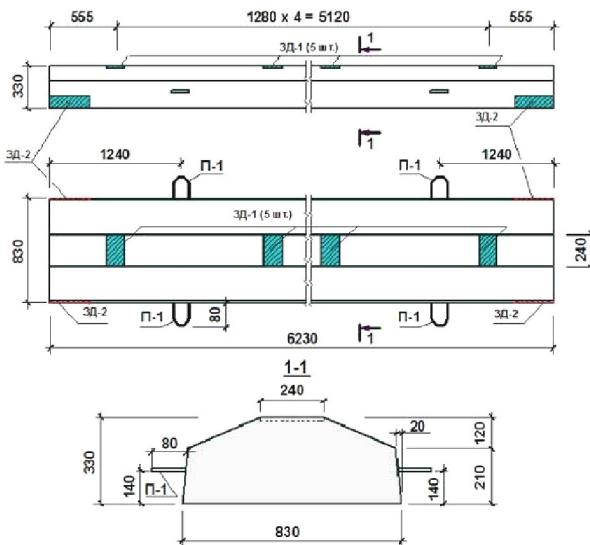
Основные размеры инвентарных железобетонных балок
